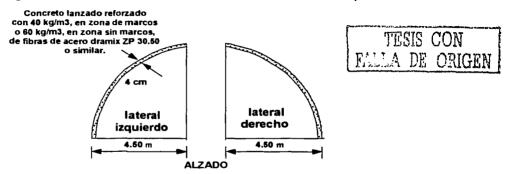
Colocación de una capa primaria de concreto lanzado reforzado con fibras de acero hasta alcanzar un espesor de 4 cm.
